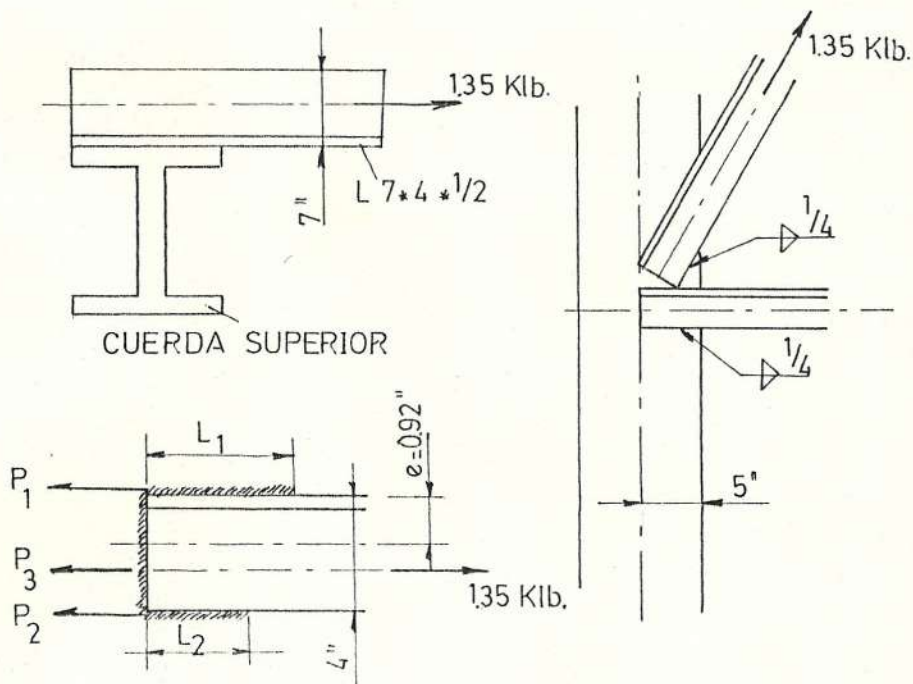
DISEÑO DE LA UNIÓN SOLDADA DEL ARRIOSTRAMIENTO.
